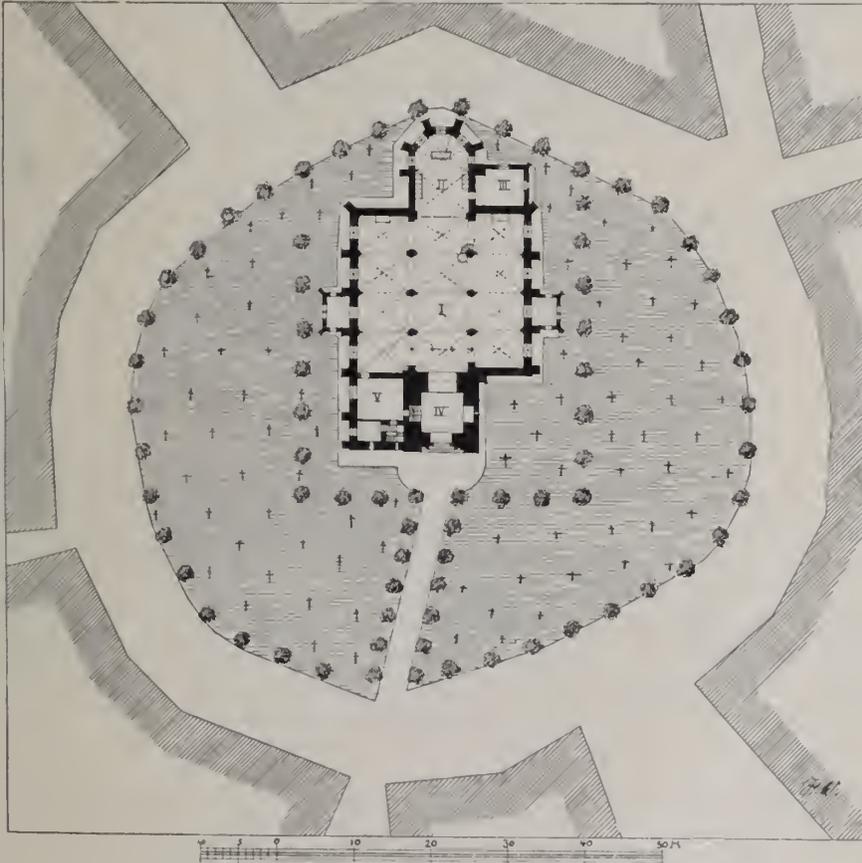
S. Tonis. Grundriss der Pfarrkirche
